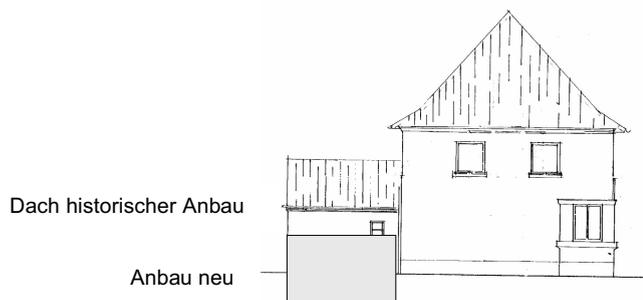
B *Zweigeschossiger Haustyp mit neuem Anbau (Haustyp 3, 5, 9, 11)
